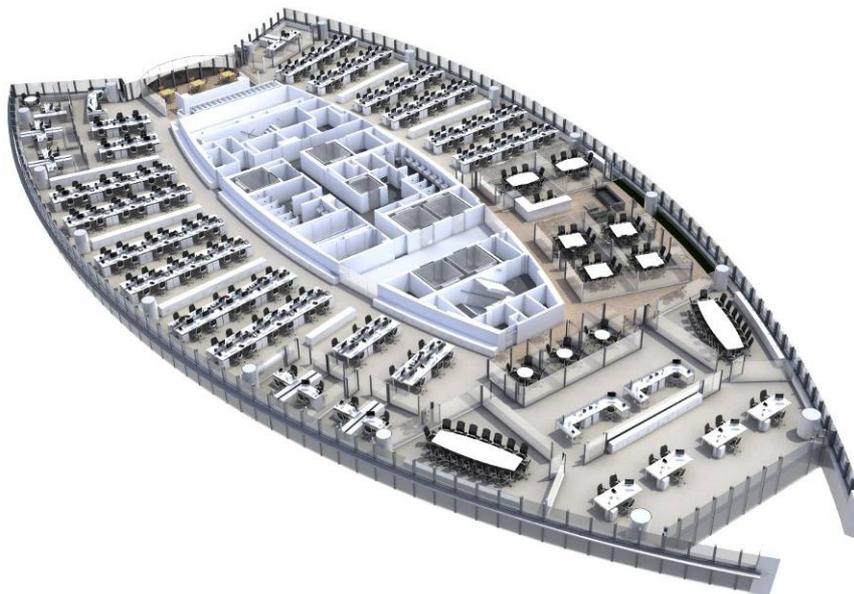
Imagem do andar tipo demonstrando a posição do core junto à fachada norte
